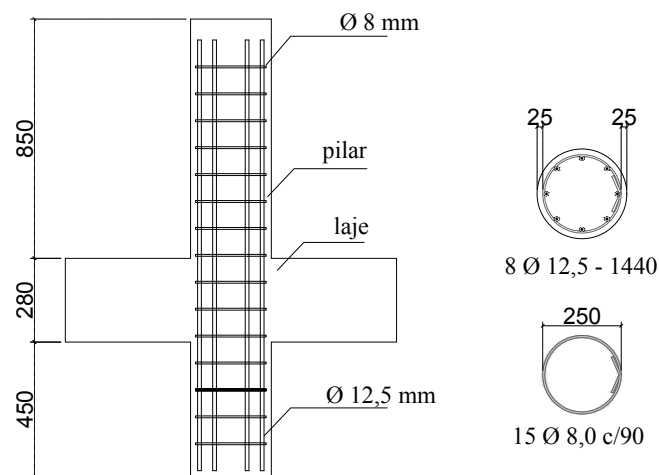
Detalhe armadura dos pilares, medidas em mm
